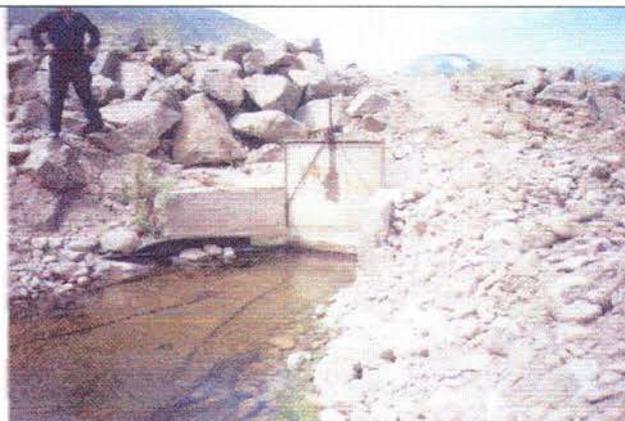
Bocatoma. Compuerta de acceso metálica y posteriormente continúa un tubo de aproximadamente 20 m de longitud.
